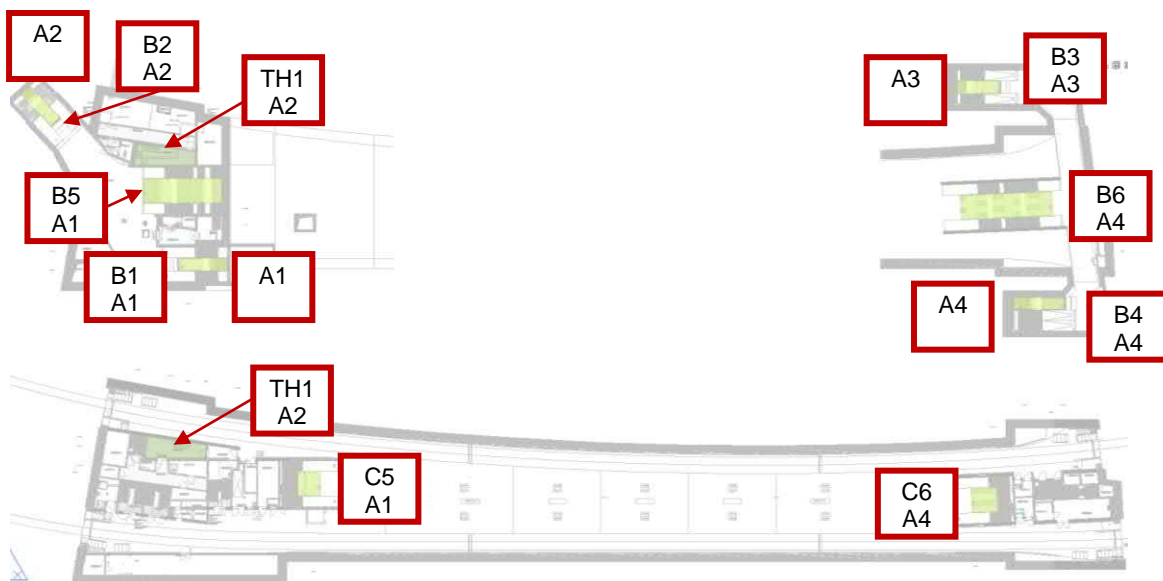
Grundrisse B- und C-Ebene mit Darstellung der Treppennummerierungen
